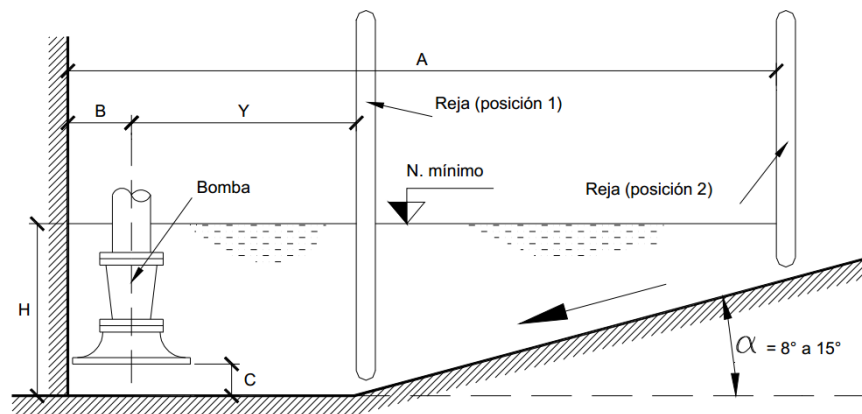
Disposiciones geométricas recomendadas. Fuente: (HYTSA)²⁰
